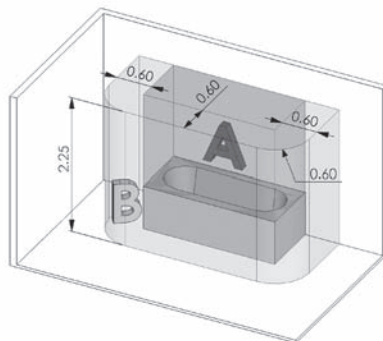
Zona de instalación / A : Volumen estructura / B : Volumen de protección
